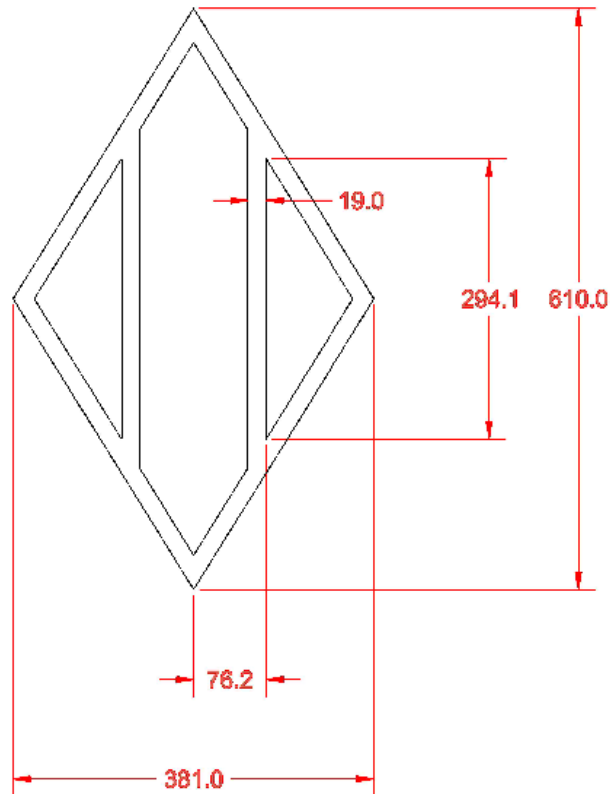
Section type du mât construit avec des plaques de 19mm d'épaisseur soudées longitudinalement
